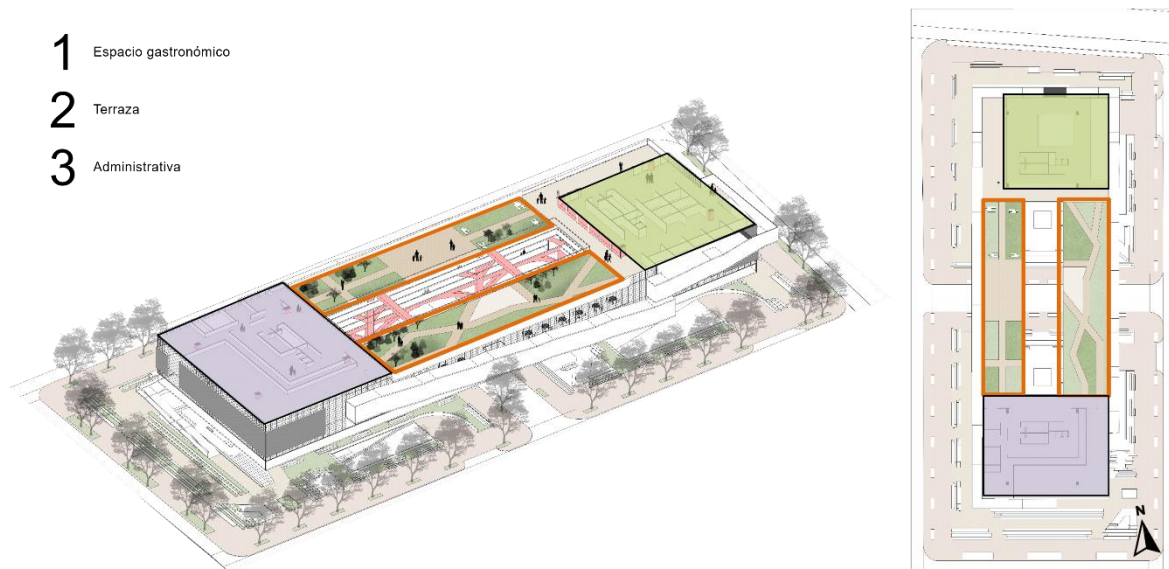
sistema de usos y configuración espacial planta 4 – elaboración propia 2021
